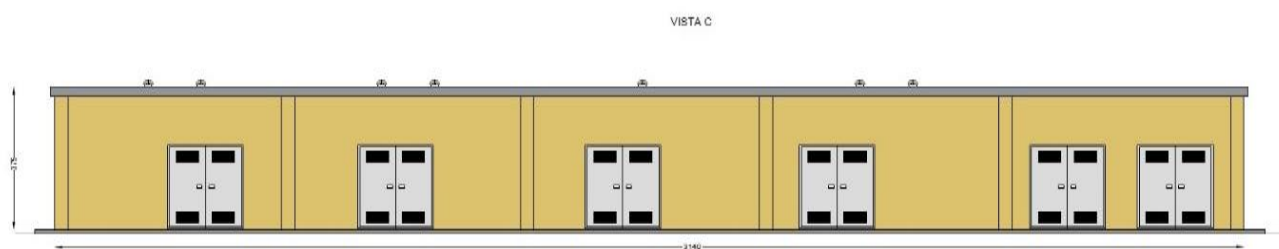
Prospetto fabbricato stazione di utenza (misure in cm)
